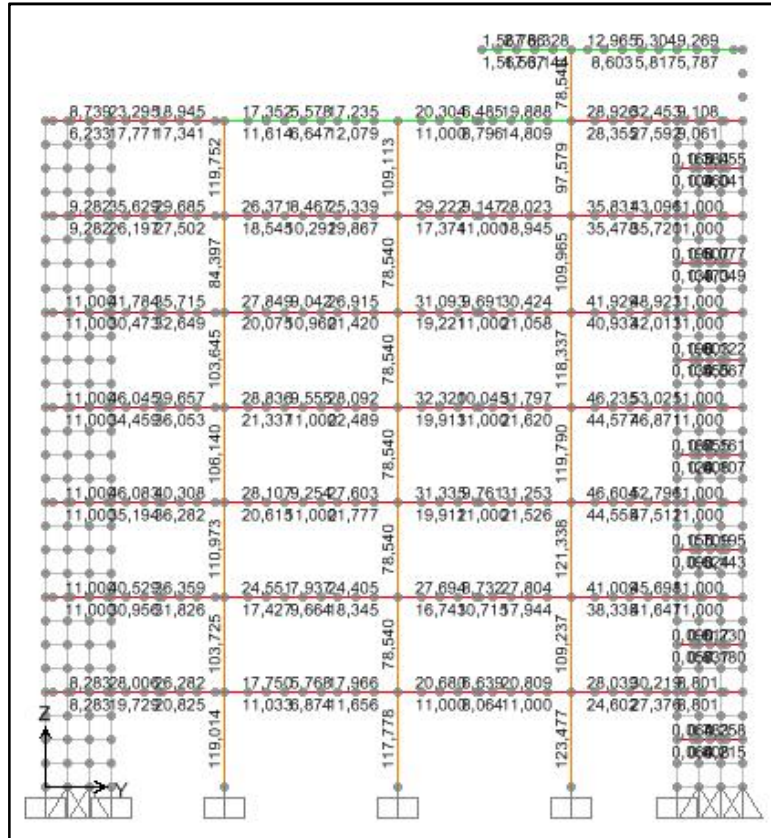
Acero en vigas pórtico 9, Hall Central
